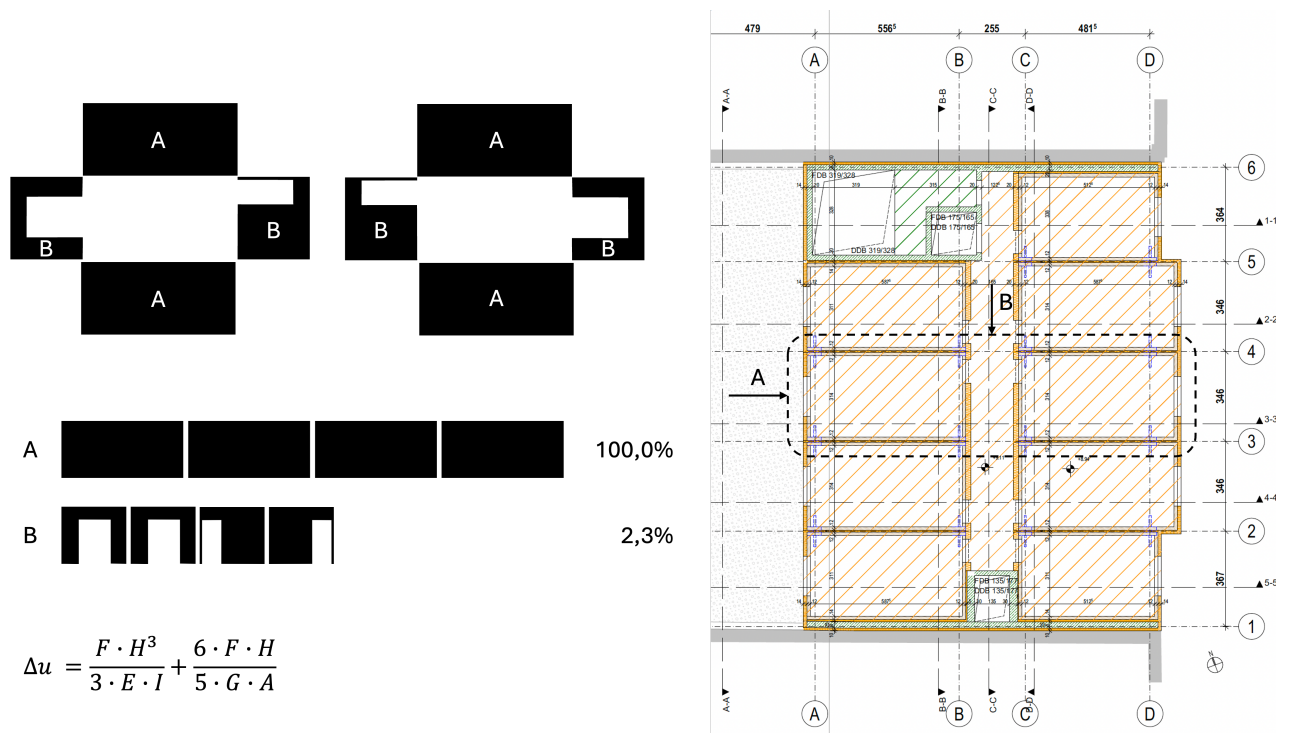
Grundriss eines Regelgeschoßes (rechts), Darstellung der aussteifenden Wandflächen und deren Steifigkeiten im Vergleich zueinander [8]
